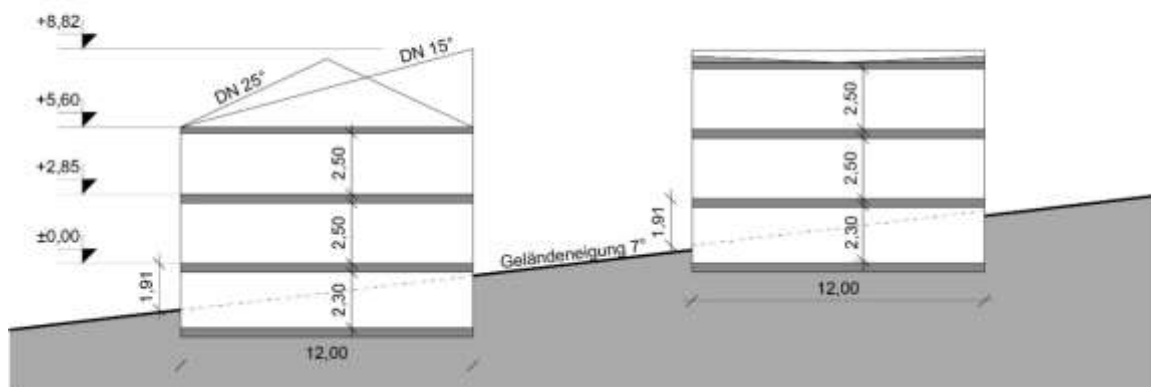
mögliche Bebauung bei 2 zulässigen vollgeschossen (Beispiel)
